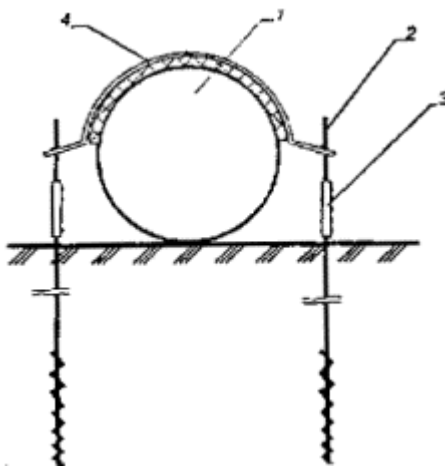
Вмораживаемое анкерное устройство стержневого типа: 1 – трубопровод; 2 – тяга из арматурного стержня периодического профиля; 3 – ограничитель усилий; 4 – силовой соединительный пояс
